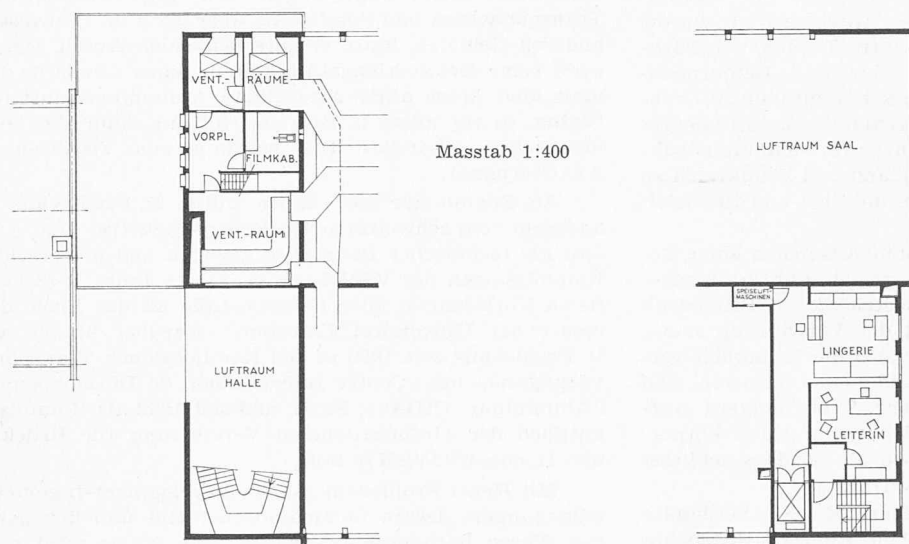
Grundriss 2. Zwischengeschoß
